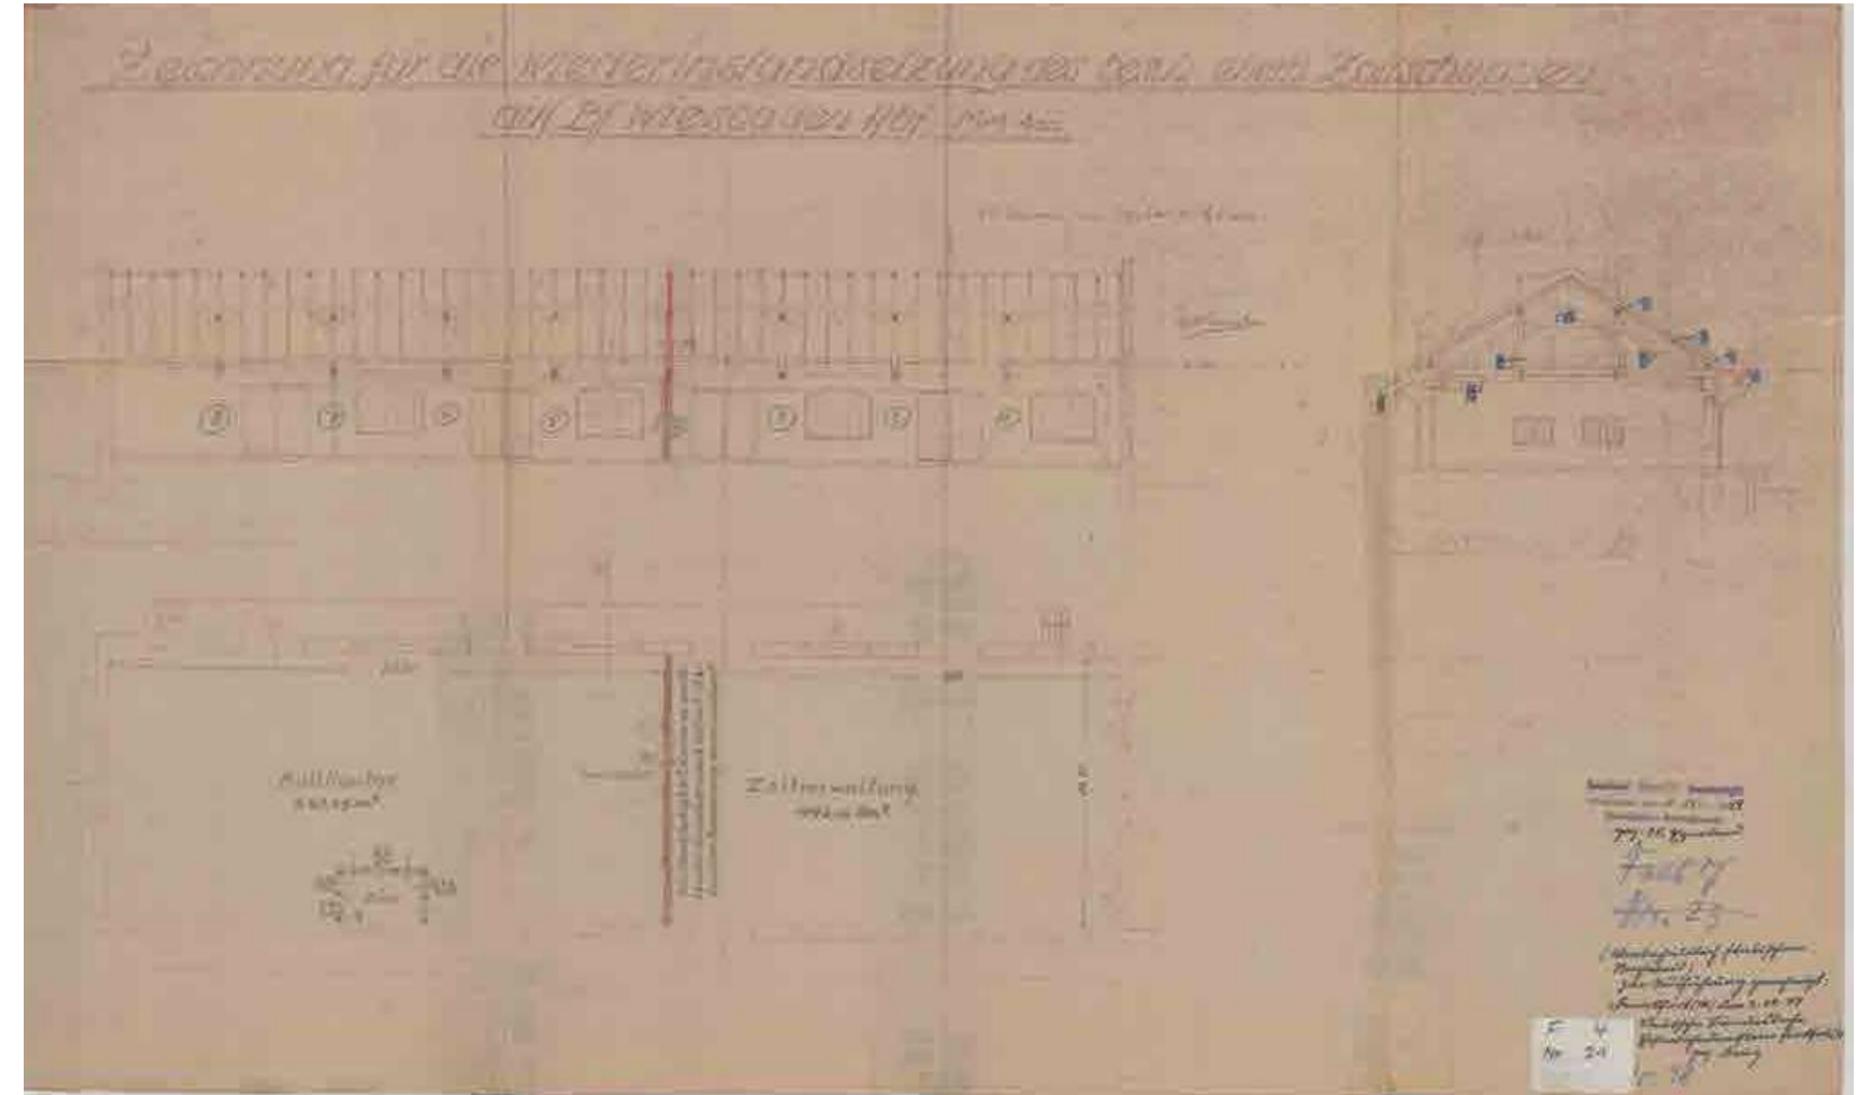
Zollschuppen: Plan zur Wiederherstellung des Zollschuppens, 1949
